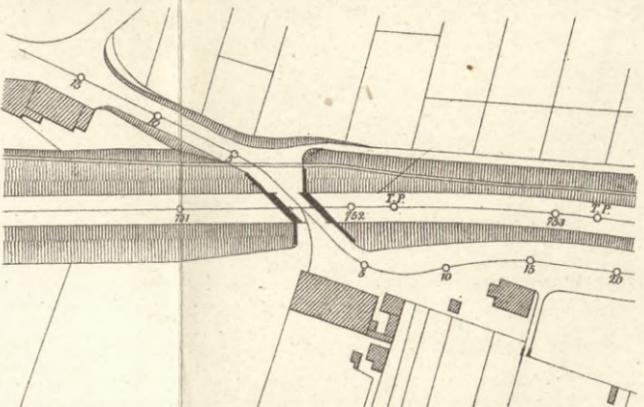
Brücke über die Vocke nebst Durchfahrt.
